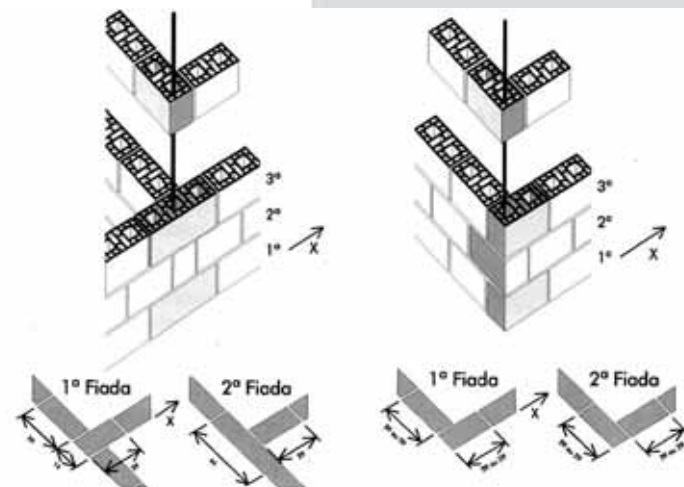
Detalhes alvenaria estrutural. Fonte: RAMALHO, M.A. & CORREA, M.R.S. *Projeto de Edifícios de Alvenaria Estrutural*. Editora PINI. São Paulo,
